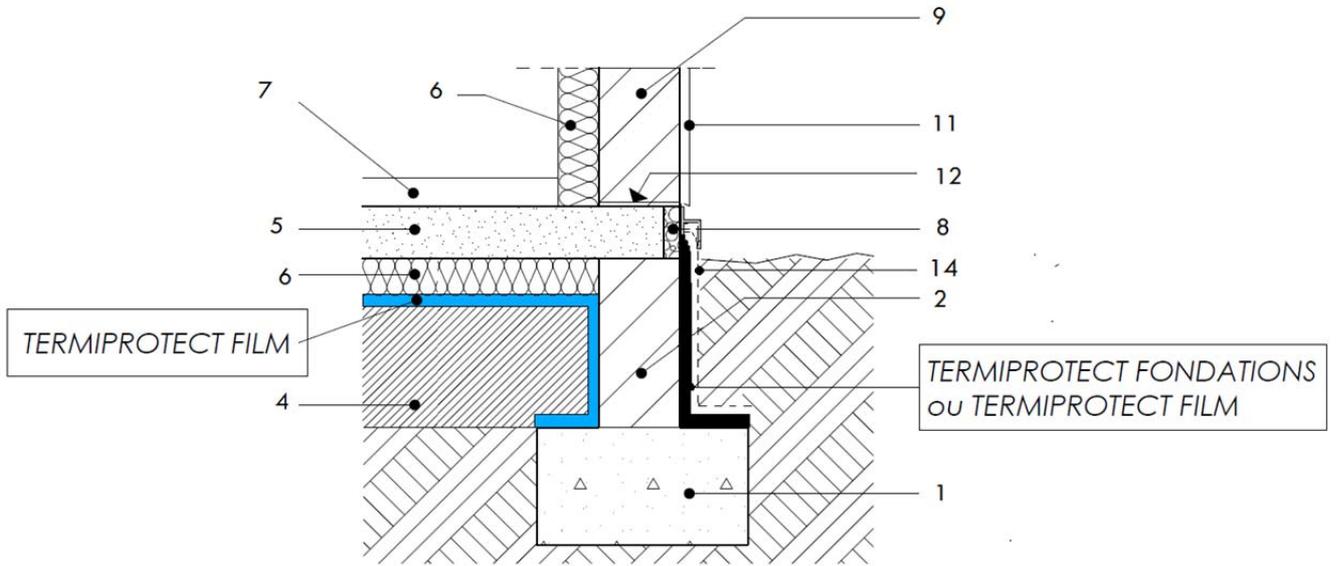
Dallage solidarisé avec planelle, soubassement en maçonnerie - isolant non résistant aux termites
